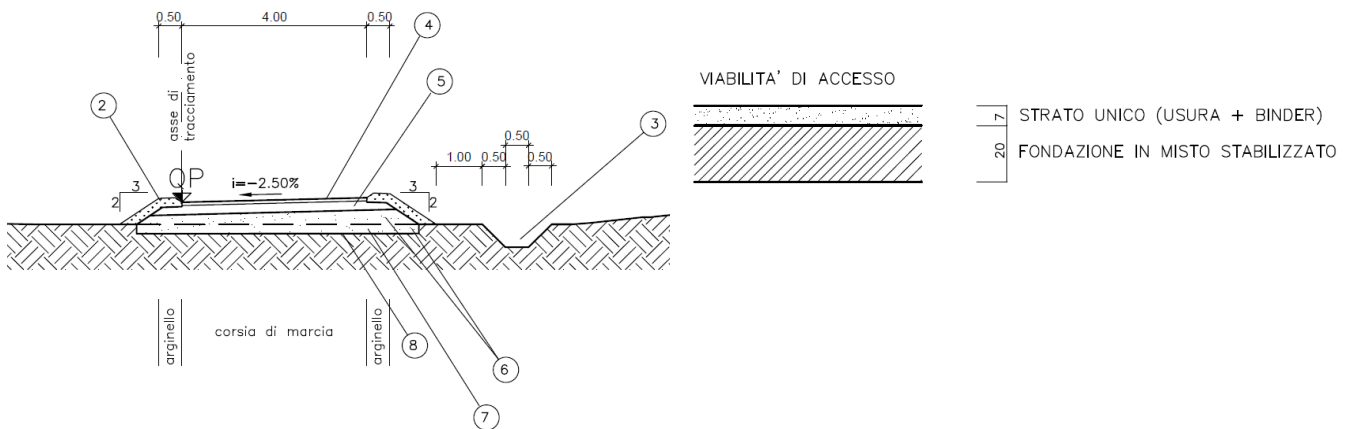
sezione tipo e dettaglio della sovrastruttura stradale
